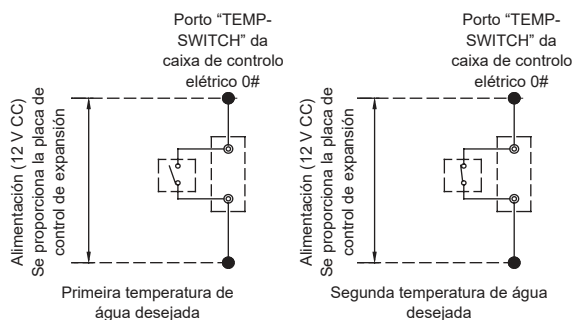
Cablagem do porto elétrico fraco "TEMP-SWITCH"
